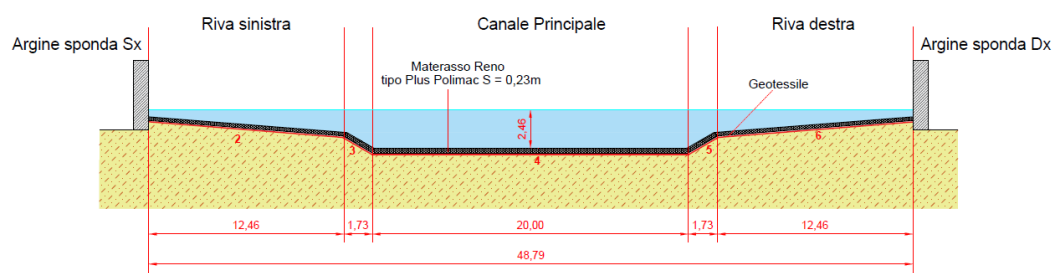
Progettazione dell'opera longitudinale in una sezione tipo
